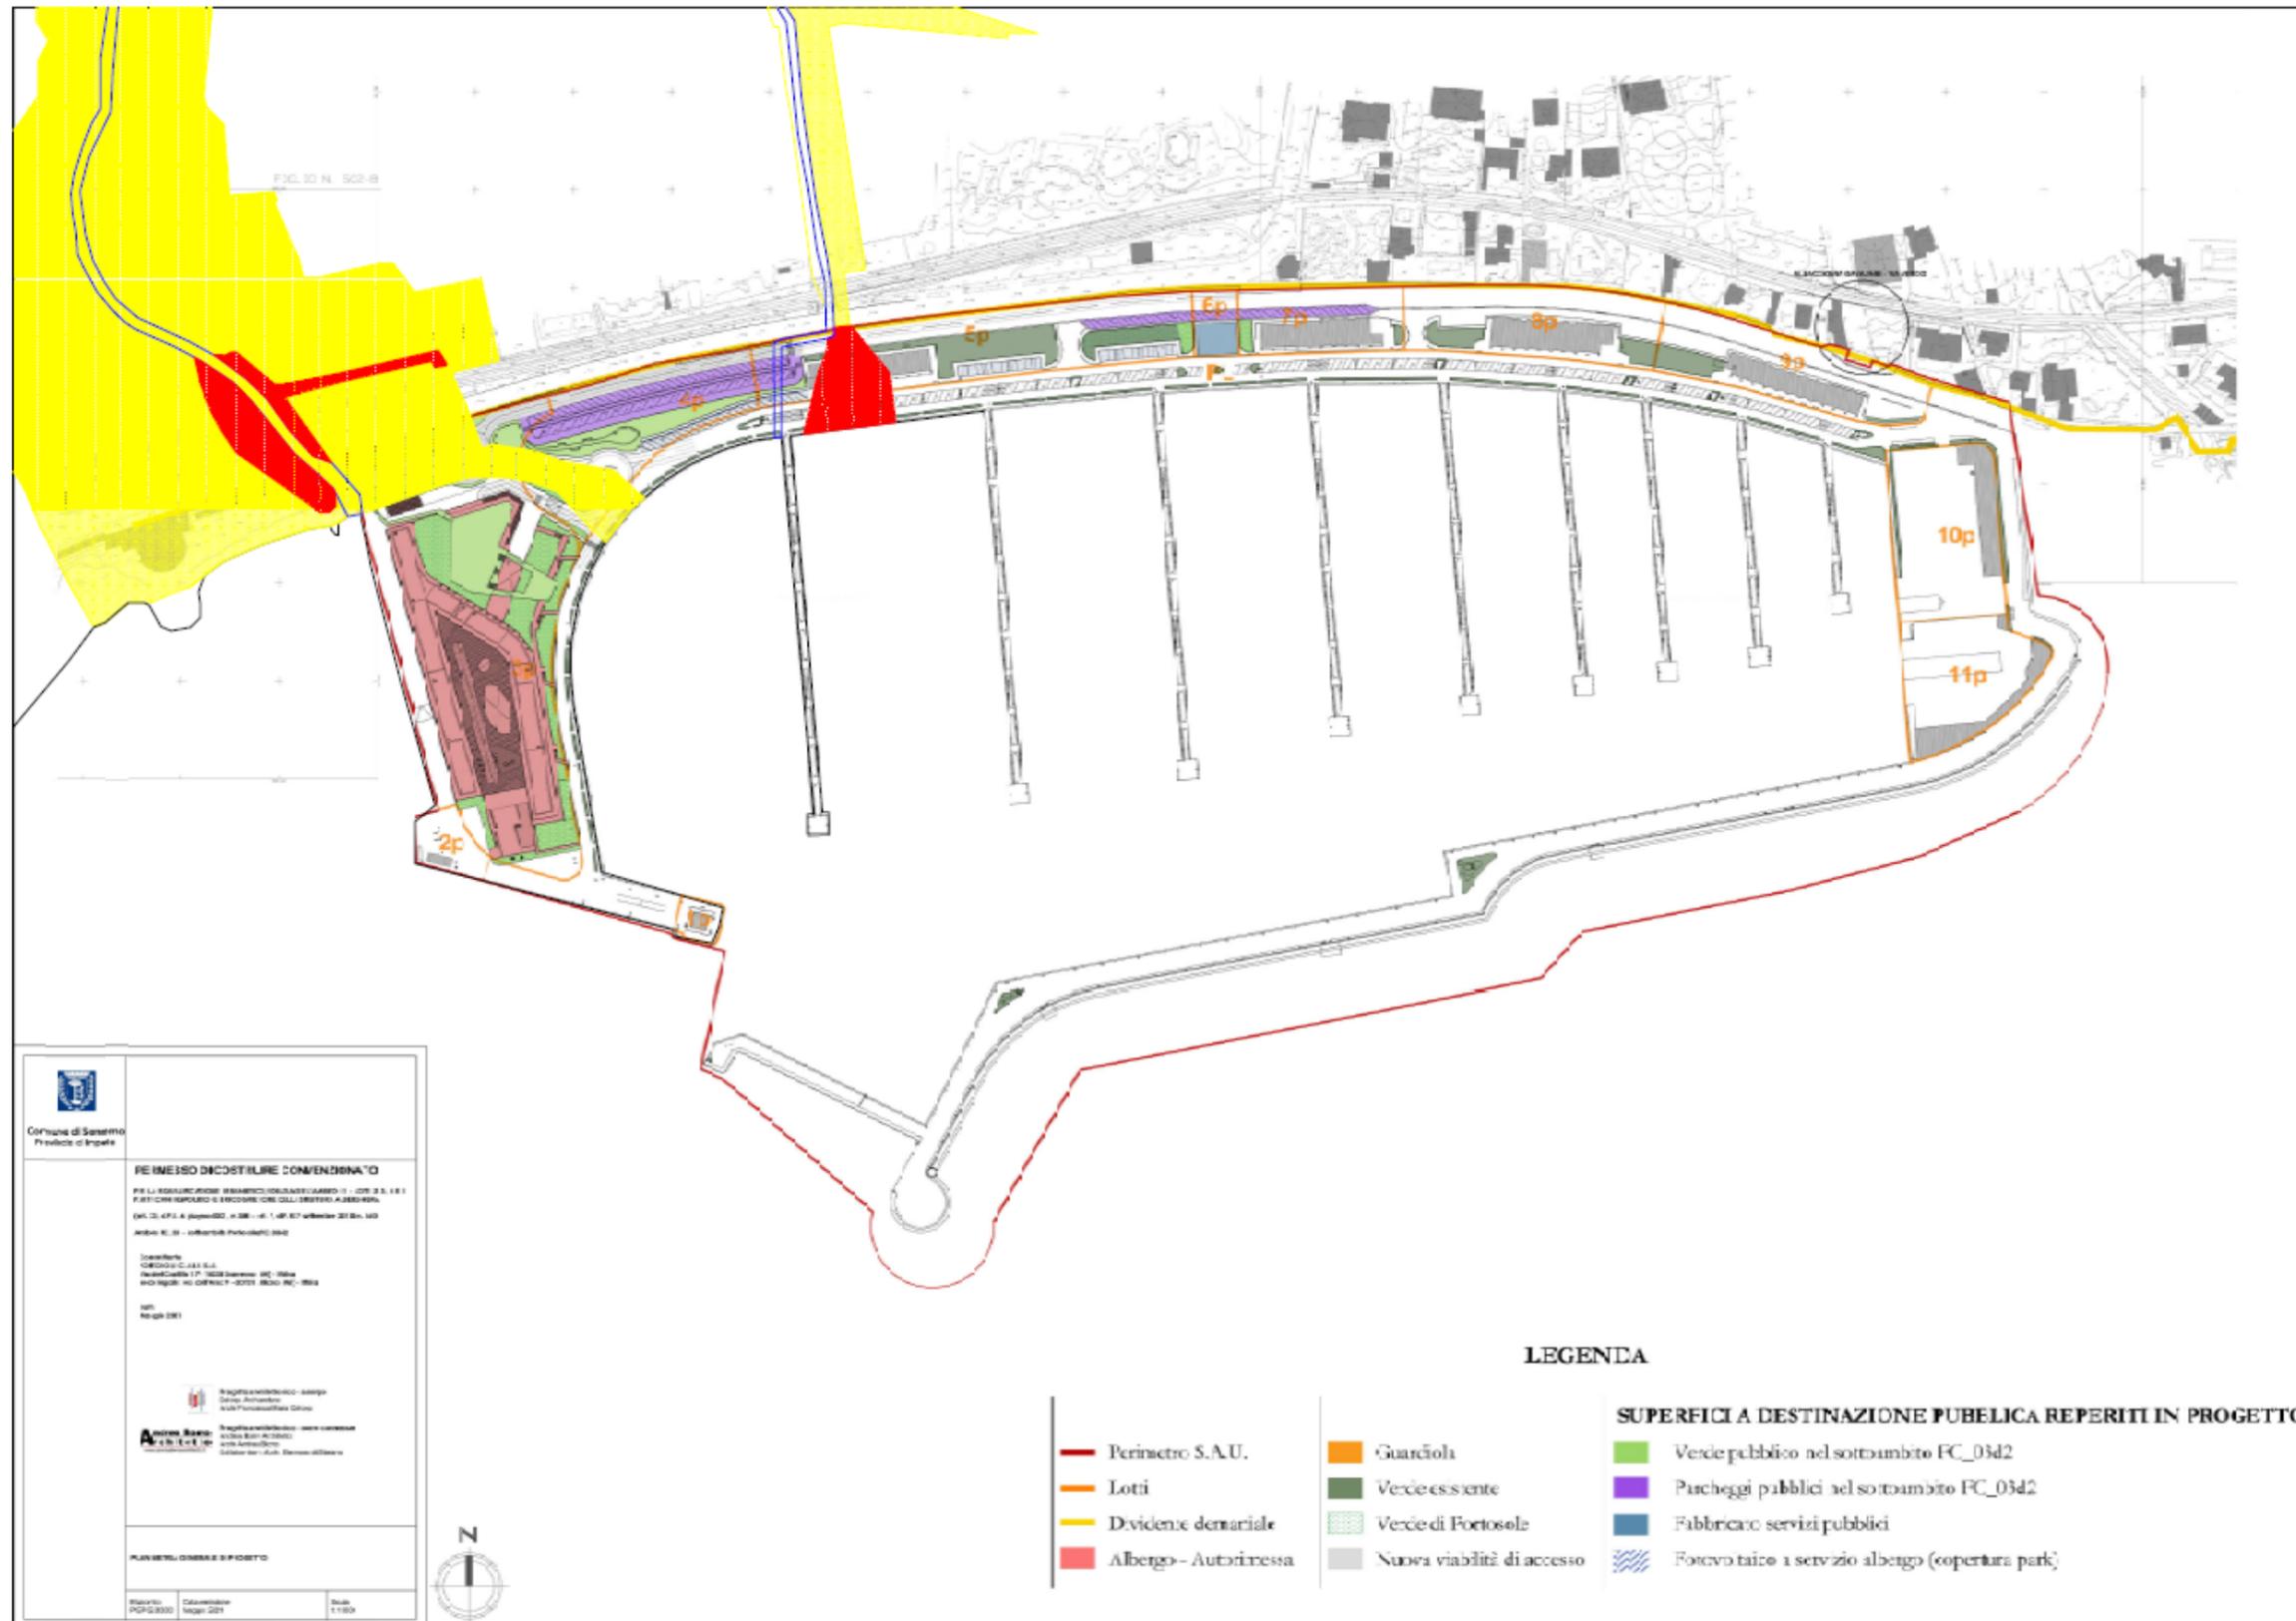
Vista d'insieme dello stato di progetto con la sovrapposizione delle fasce di inondabilità dei Torrenti San Lazzaro (a sinistra) e Rubino (a destra)
